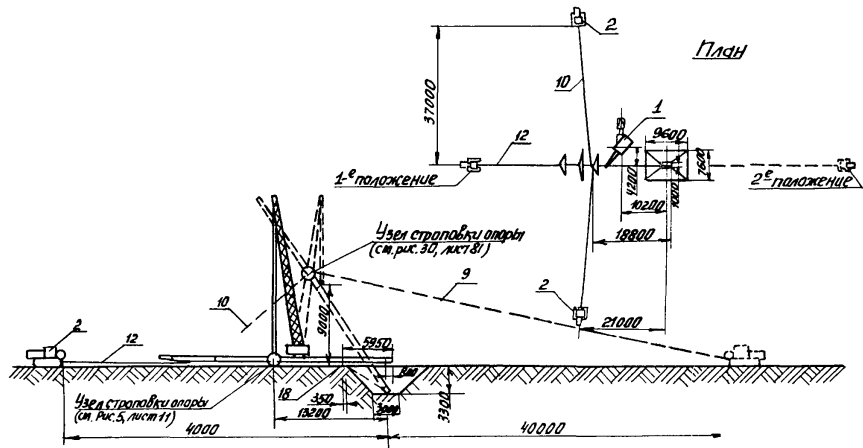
Схема установки железобетонных опор на ВЛ 110, 150 и 220 кВ.
